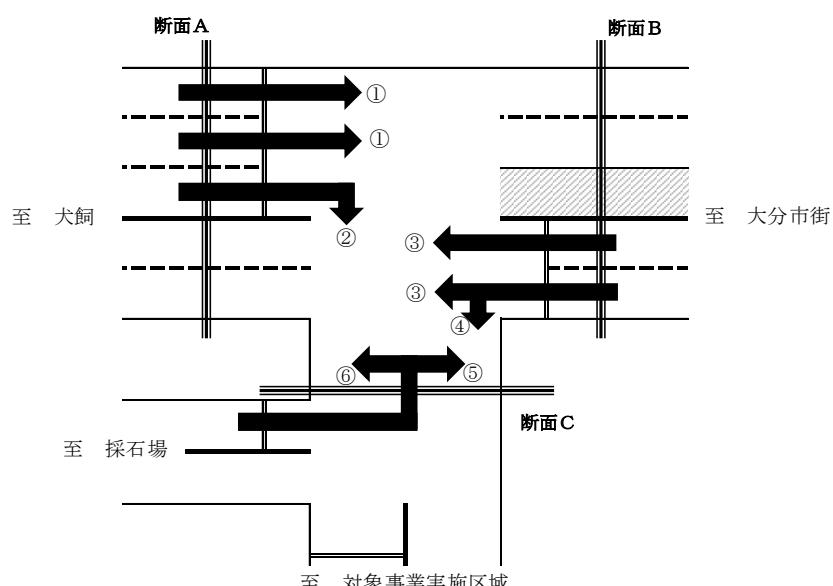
S-10 上尾トンネル北交差点平面図
